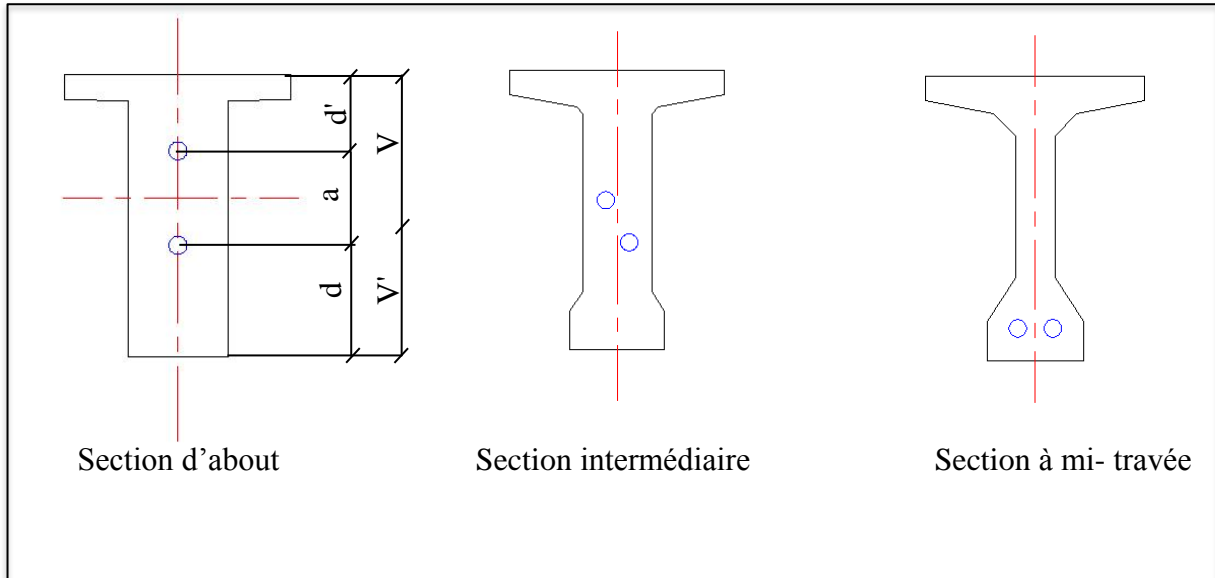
Positionnement des câbles aux différentes sections de la poutre.
